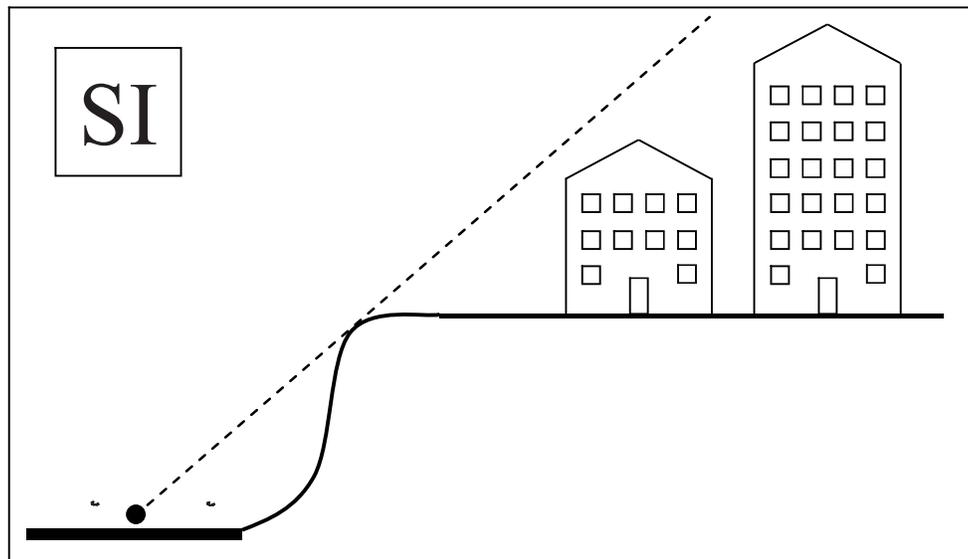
Sezione verticale riferita alla planimetria di figura L4. L'altezza delle costruzioni rispetto al piano stradale e la loro distanza dalla sede viaria sono tali da garantire una copertura acustica ai ricettori.
